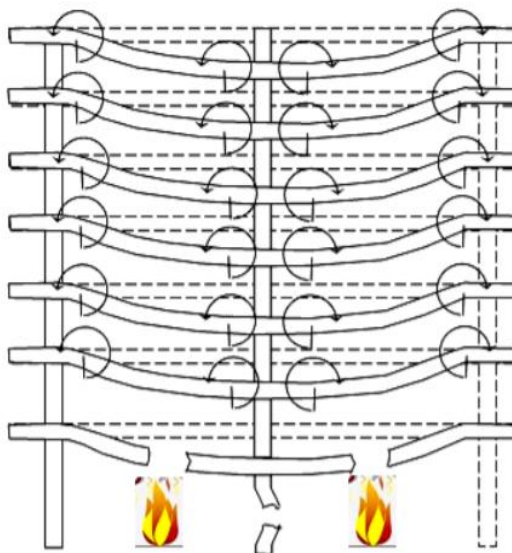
Расчетная модель, используемая для расчета прогрессивного разрушения здания с железобетонными конструкциями
